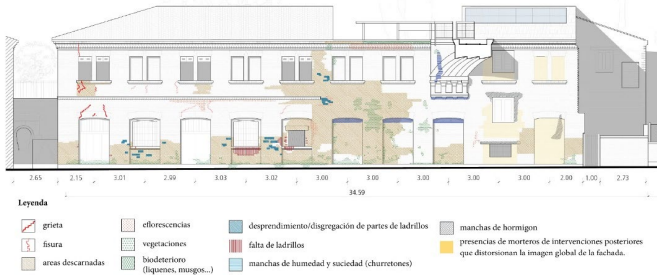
Estudio de patología de la fachada sur de la Casa del paso elevado (Casa del Cavalcavia)
